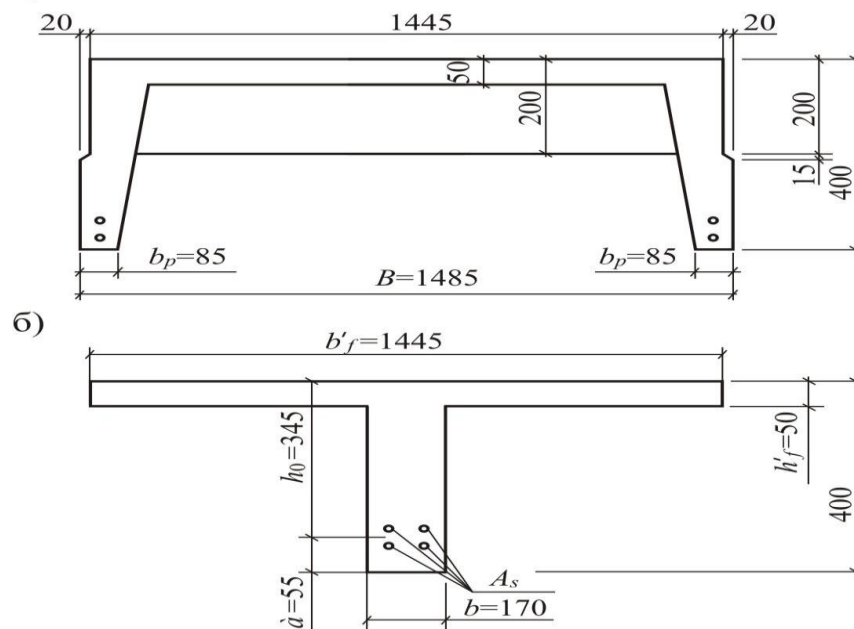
Заданий (а) і розрахунковий (б) перерізи поздовжнього ребра.
